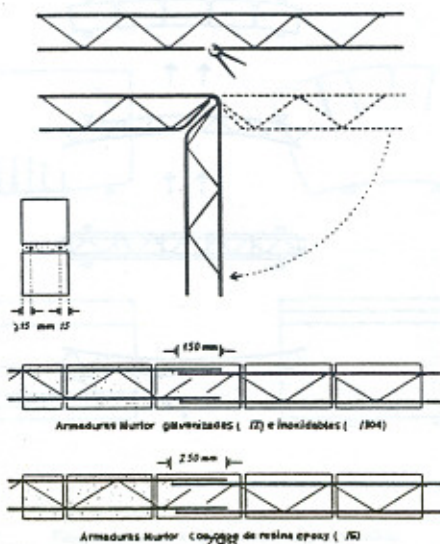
Previsiones a tener en cuenta en la colocación de las armaduras
